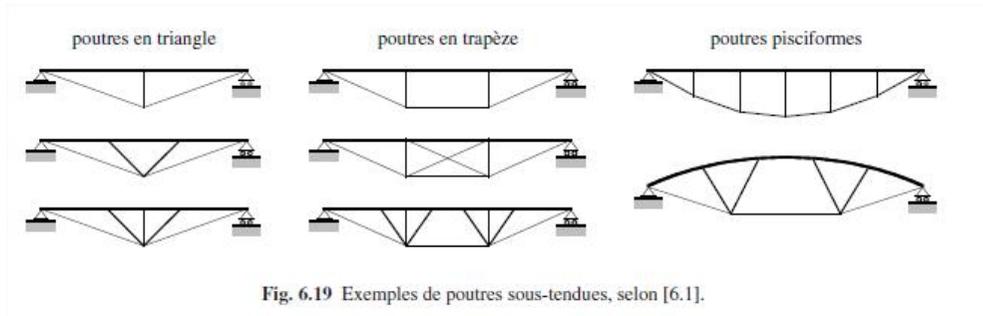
Exemples de poutres sous-tendues, selon [6.1].
